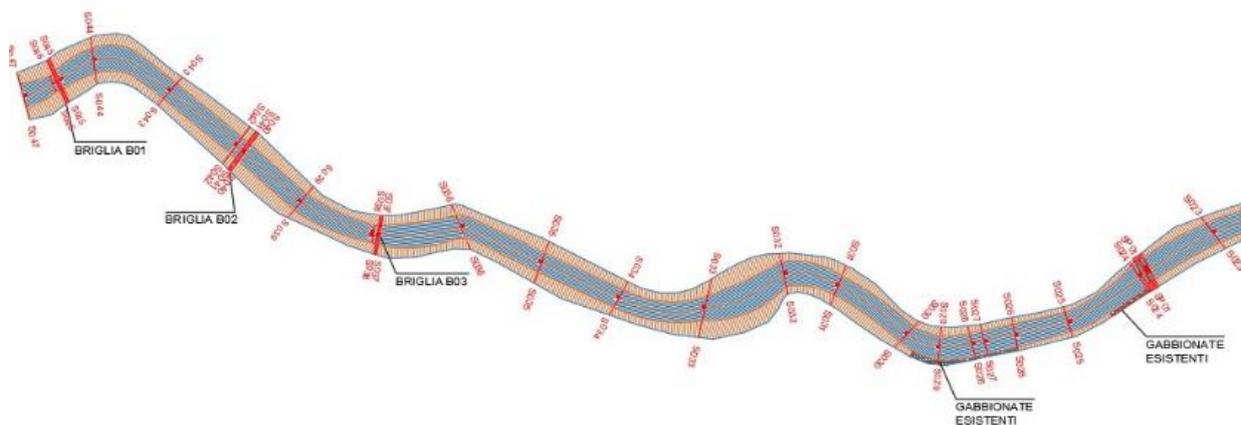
Torrente Borrone – Planimetria con dettaglio n. 2 con interventi di progetto
